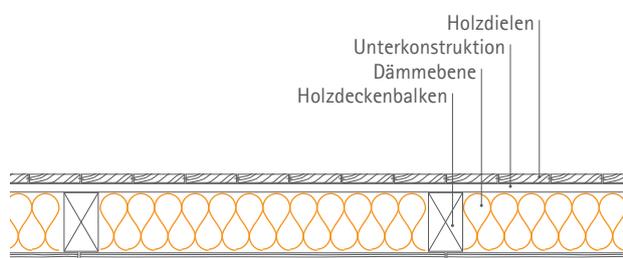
Dämmung einer Holzbalkendecke im Balkenzwischenraum
